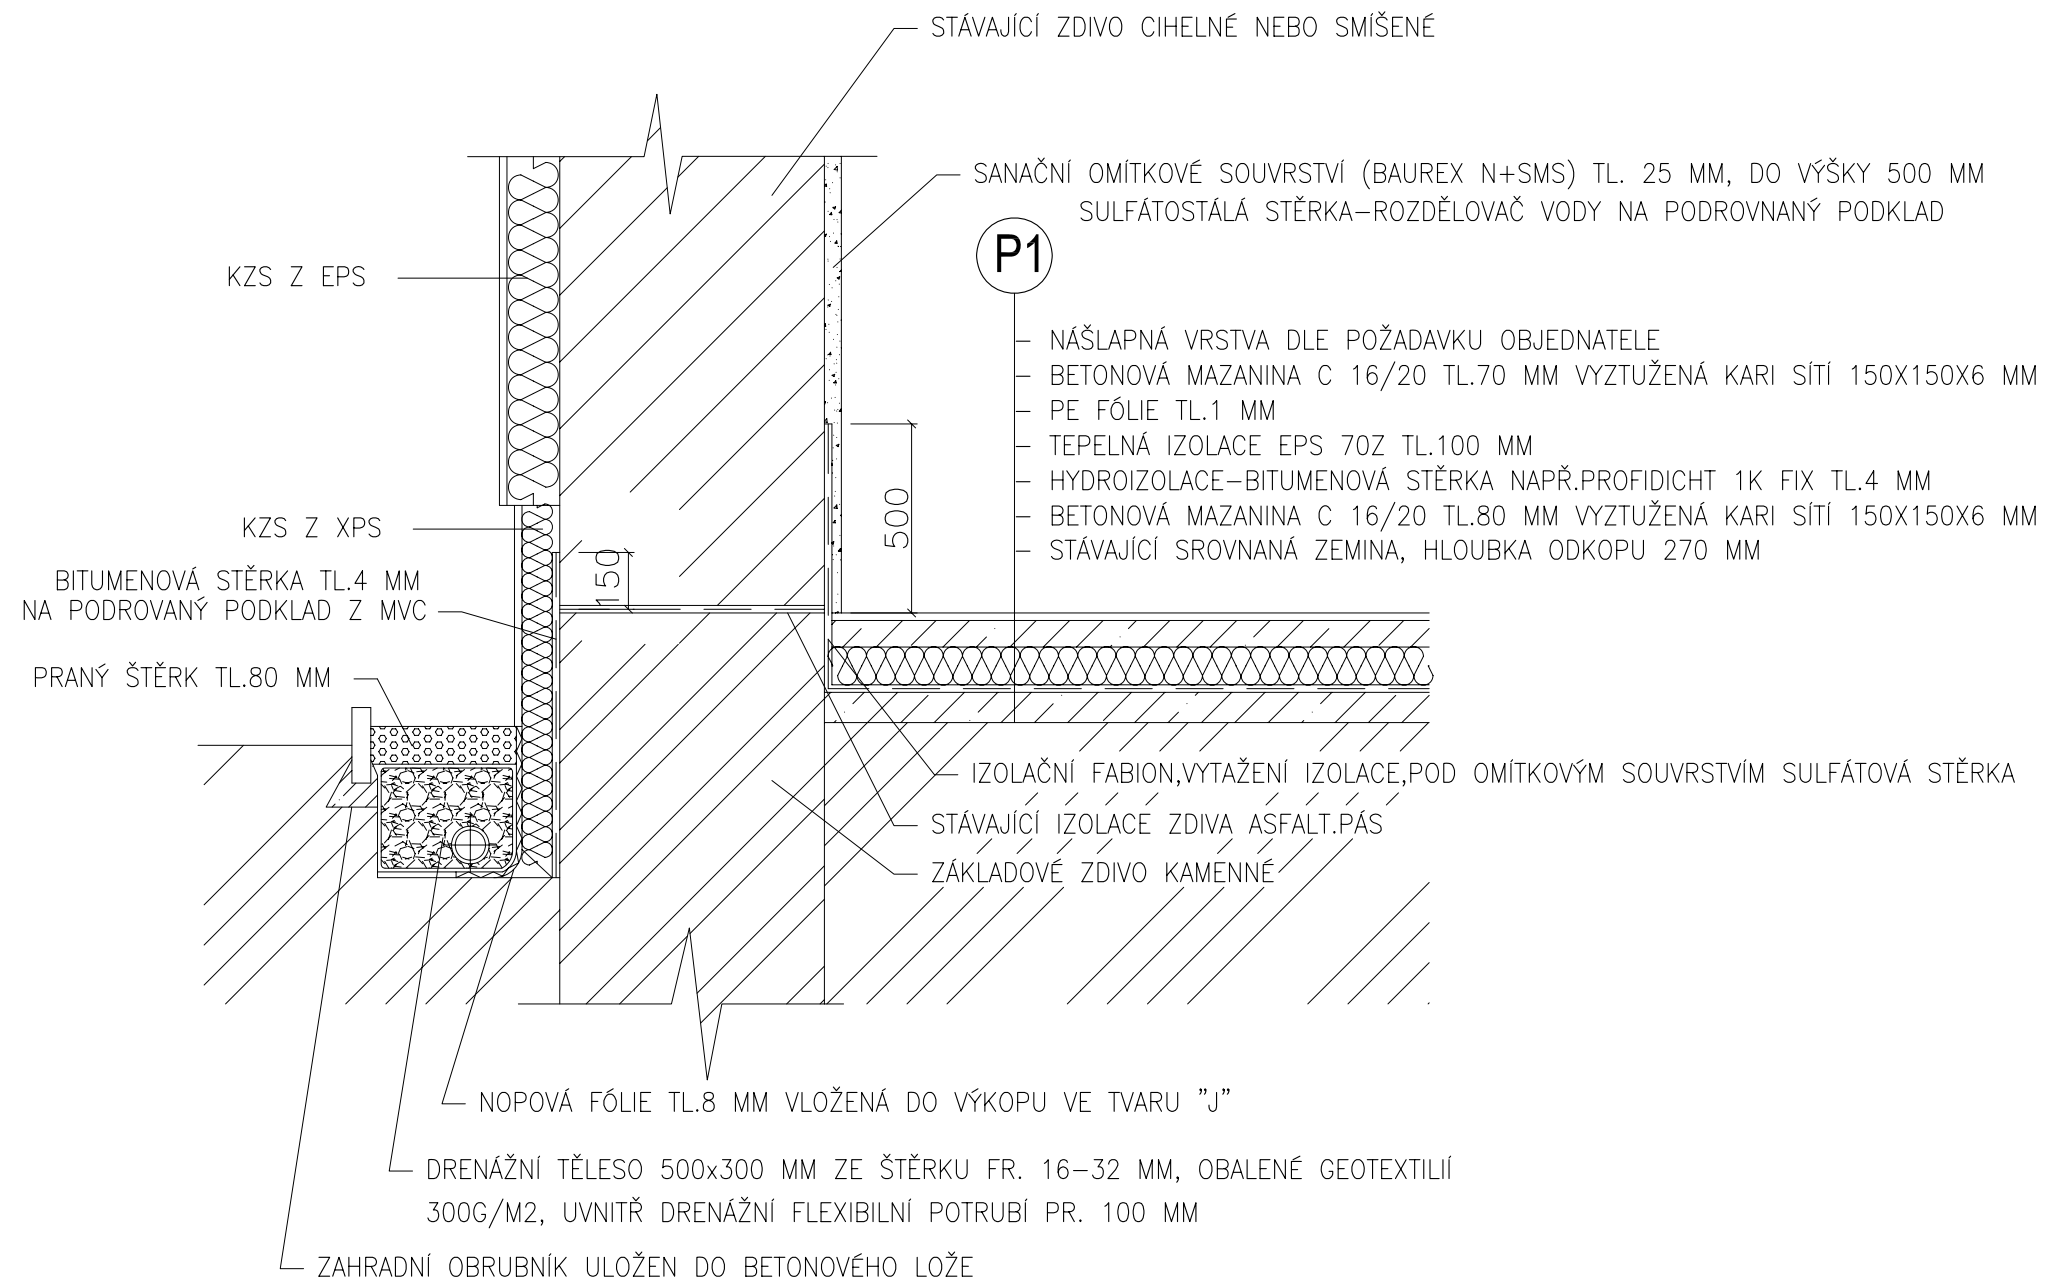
STŘEDOVÁ ZEĎ, DODATEČNÁ IZOLACE
